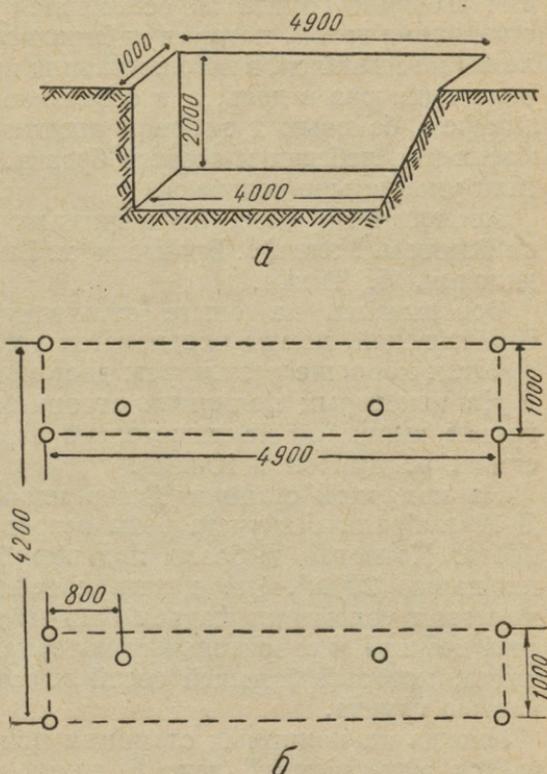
Схема котлована под фундамент ветродвигателя:
